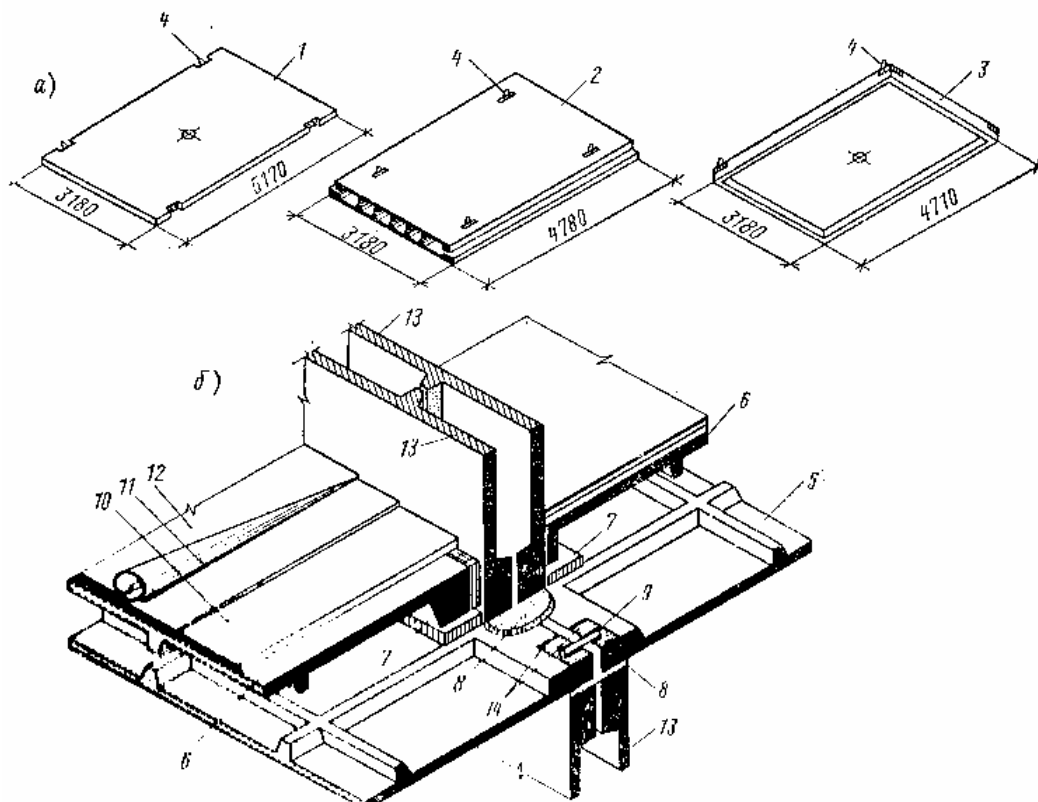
Перекрытия из панелей размером на комнату:
